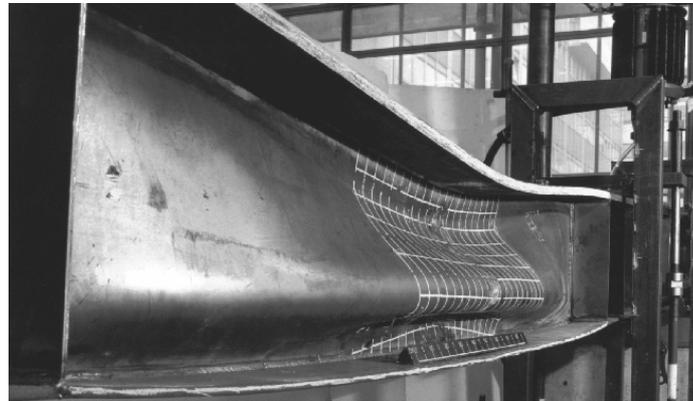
Flambagem vertical da alma de uma viga constituída de perfil I metálico.
